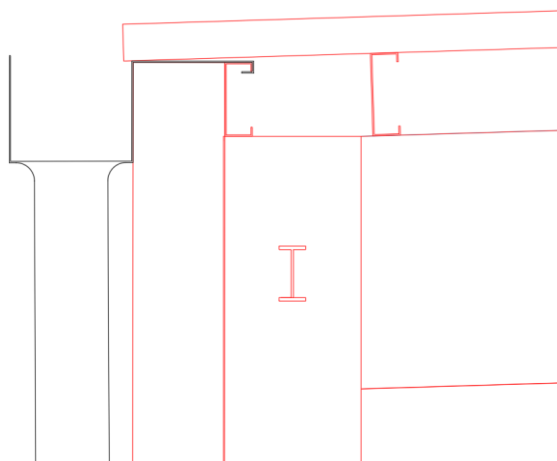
Detalle constructivo de canalón y bajantes de pluviales, sección transversal.
